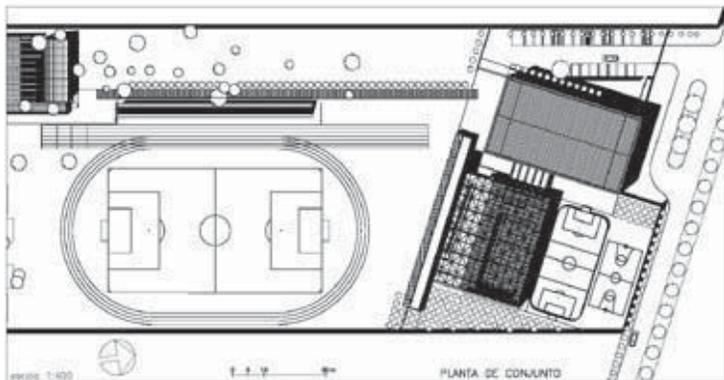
Planta de Conjunto de las instalaciones deportivas en Educare
